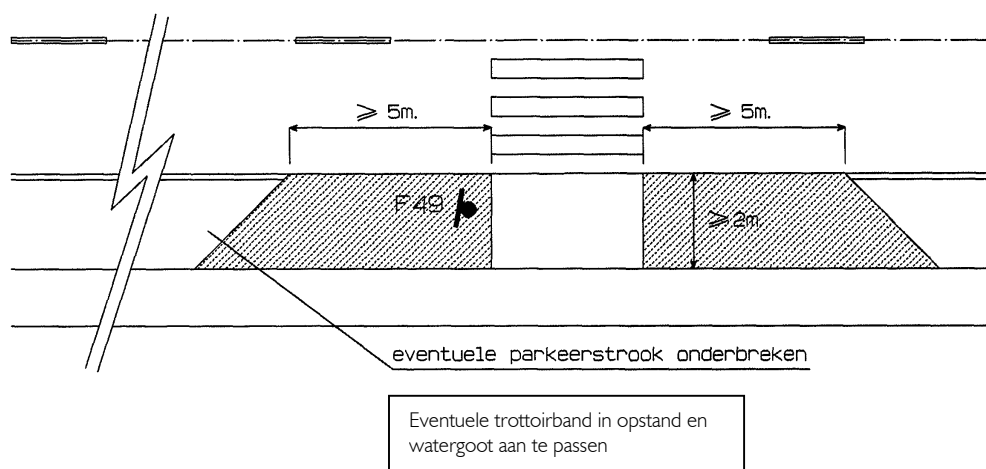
en Foto 5.37 Onderbreken parkeerstrook ter hoogte van een voetgangersoversteek
